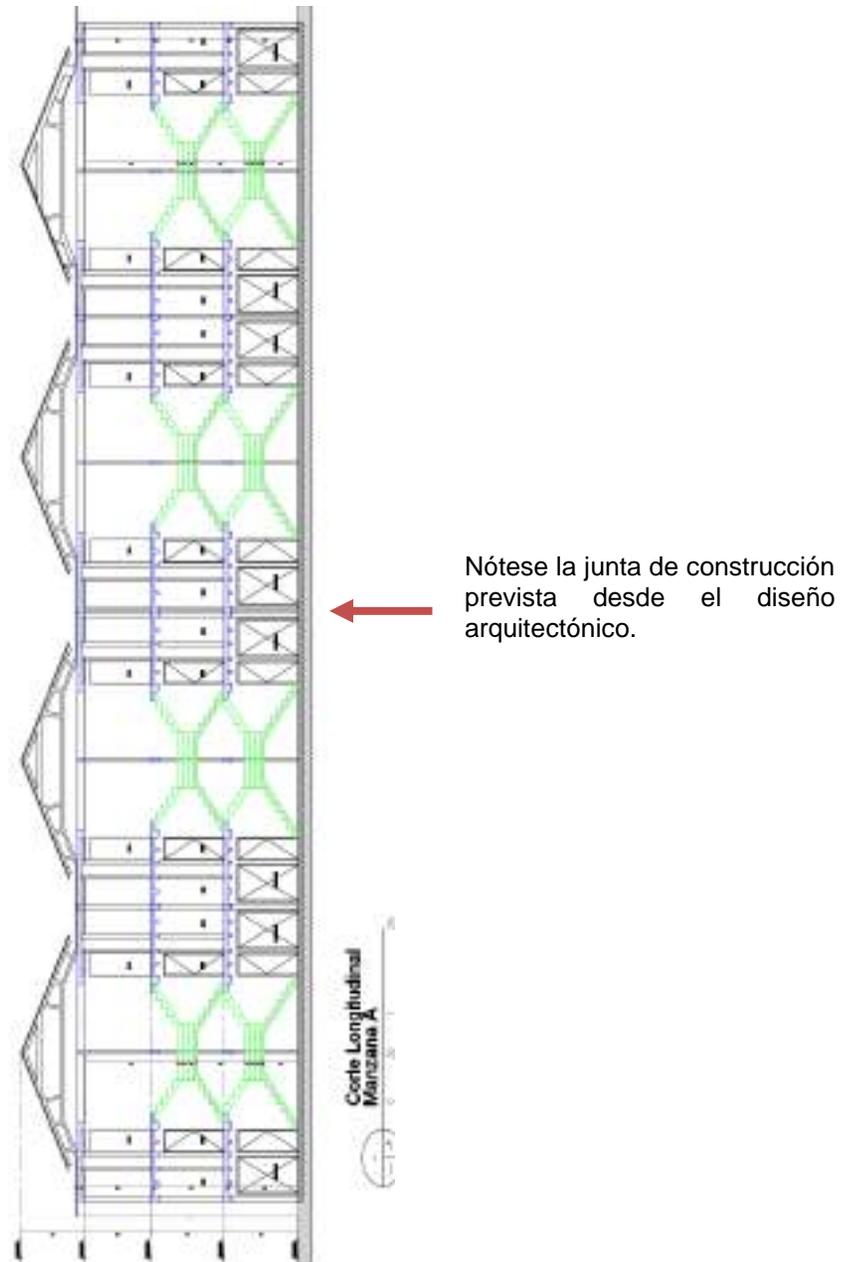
Corte A - A- Según plano A-03/05. Se aprecia la configuración de la estructura de cubierta mediante cerchas, lo cual fue omitido en la construcción, al igual que las placas de concreto previstas para la cubierta.
